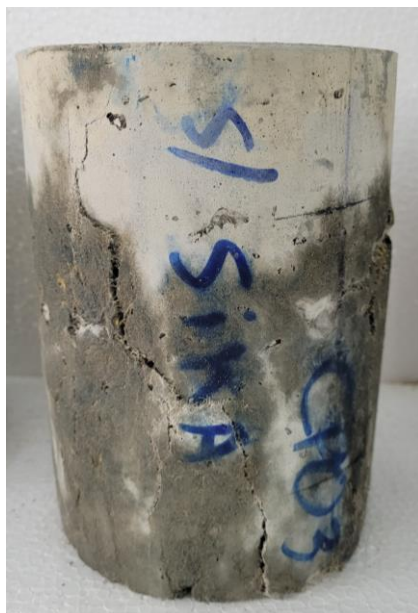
Padrão de fissuração após o ensaio de compressão aos 28 dias do CP03 reparado com dano 80% (C2-D80) camada de 2,2 cm do reparo.
